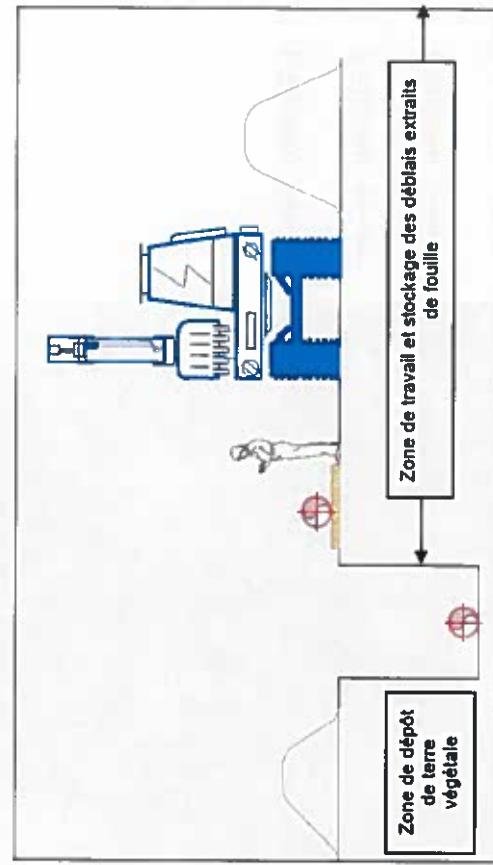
Schéma d'organisation type pour la mise en place d'une canalisat
